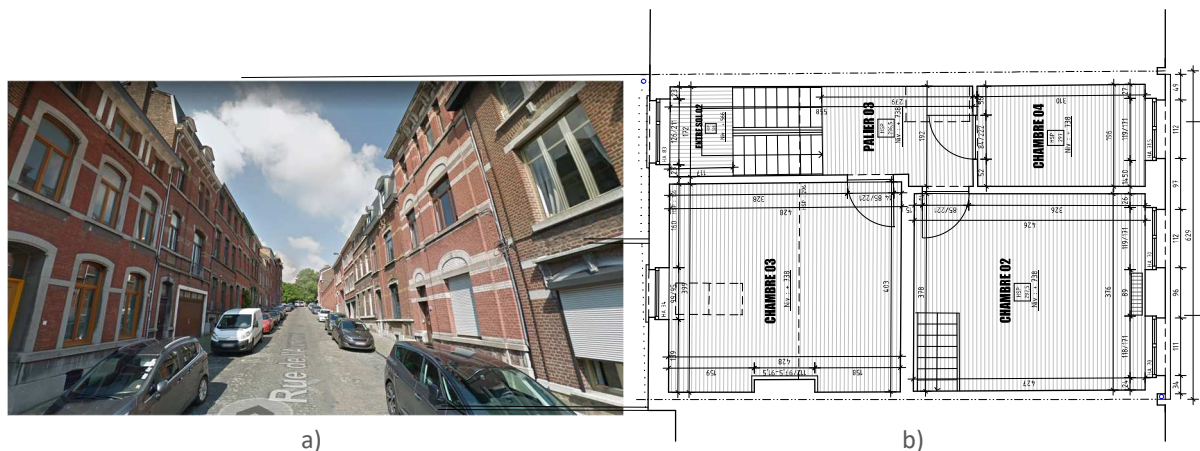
Casa B (casa burguesa): a) imagem da rua (fonte: Google maps); b) planta tipo (pisos 2).
